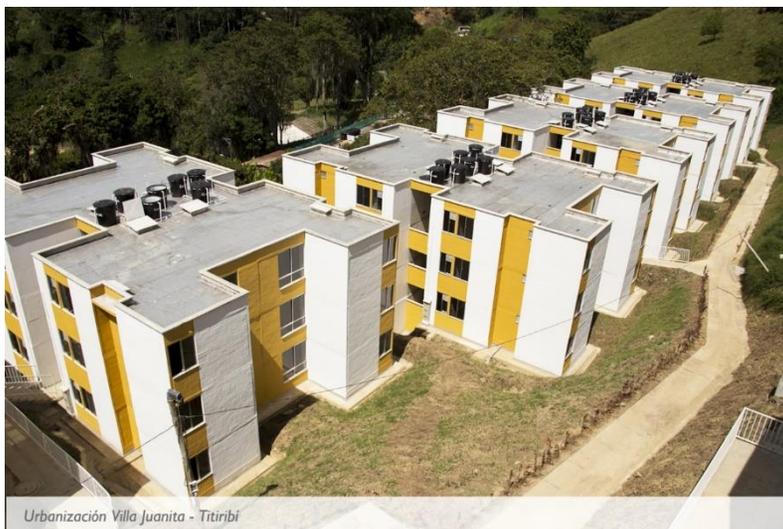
Vivienda multi-familiar con techo plano (losa de cubierta en concreto reforzado – (concreto + acero de refuerzo)).
